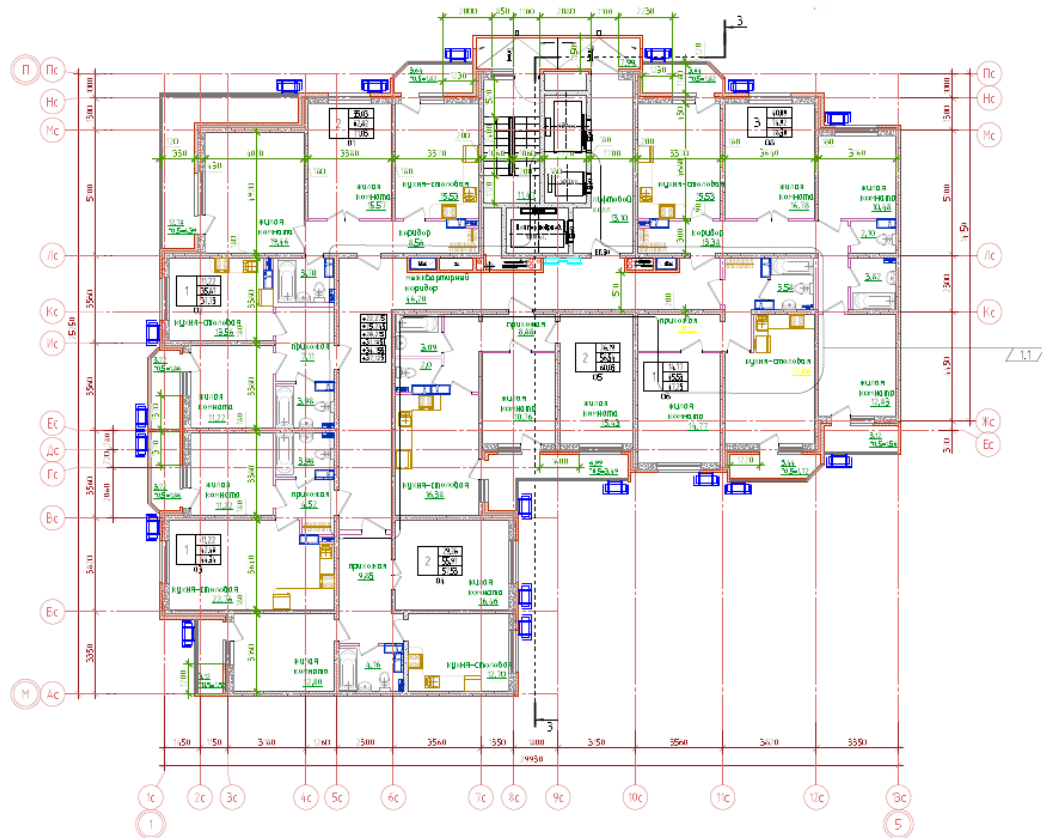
Типовой план 8-13 этажа БС-5 ЖК URAL
